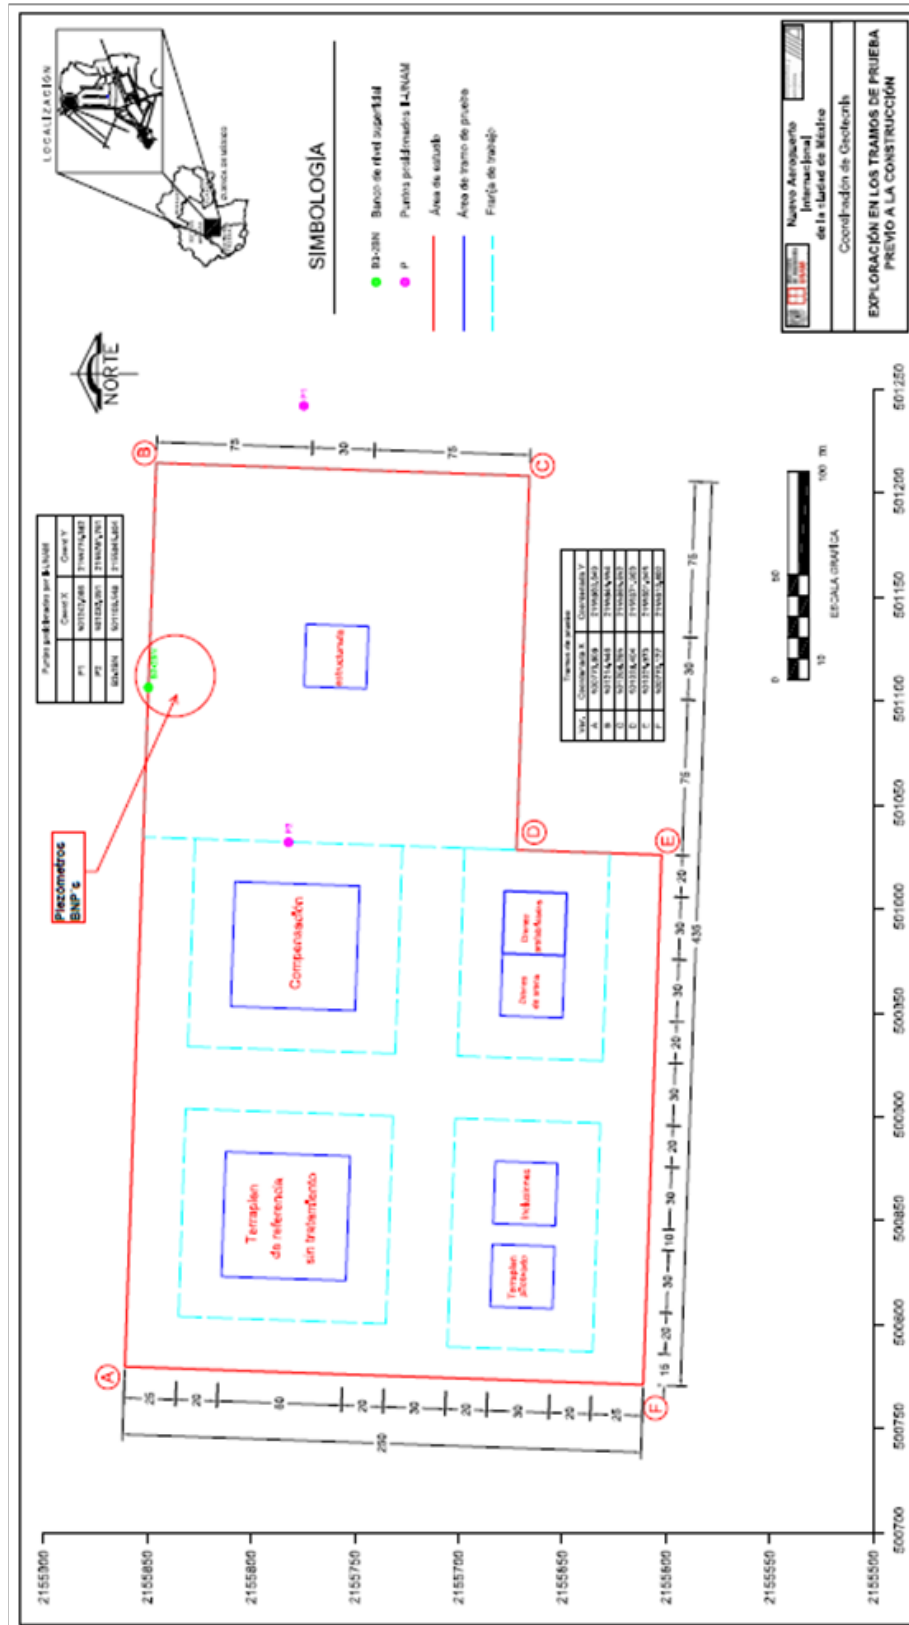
k.2 Planta general del polígono de tramos de prueba.
